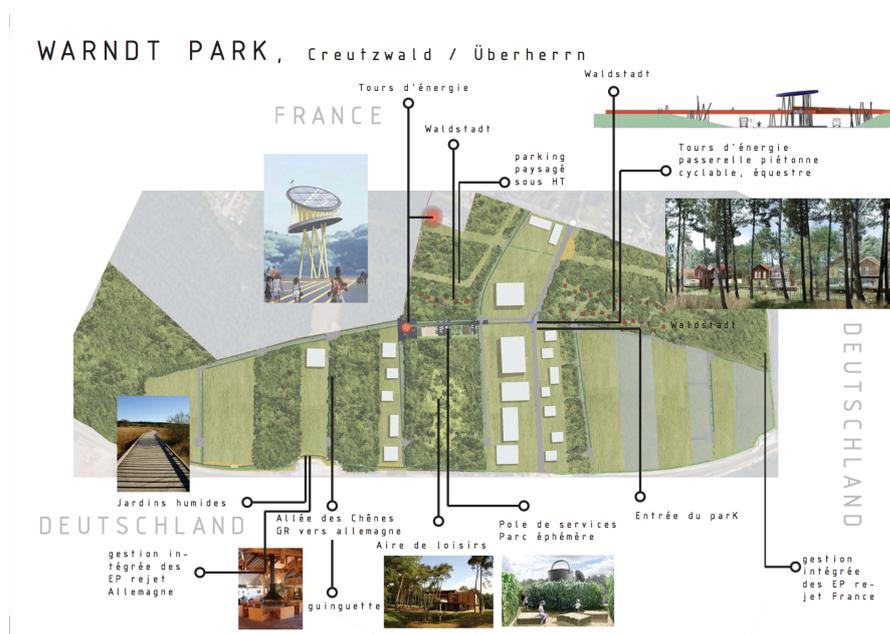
Plan masse du projet du Warndt Park (source Insitu Architectes)
